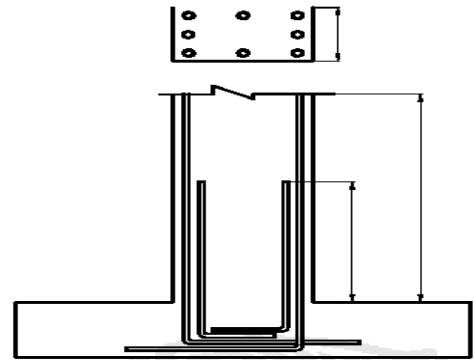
Tolerancias para columnas en la dirección del refuerzo principal
